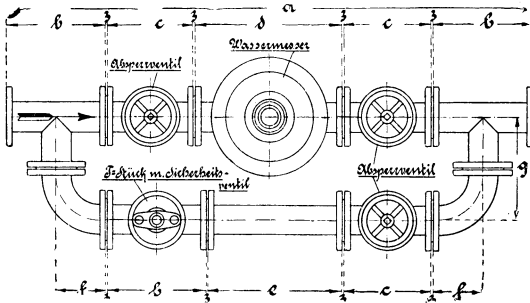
Einbau eines Wassermessers mit Umgehungsleitung und Absperrventilen (Tab. 39).
